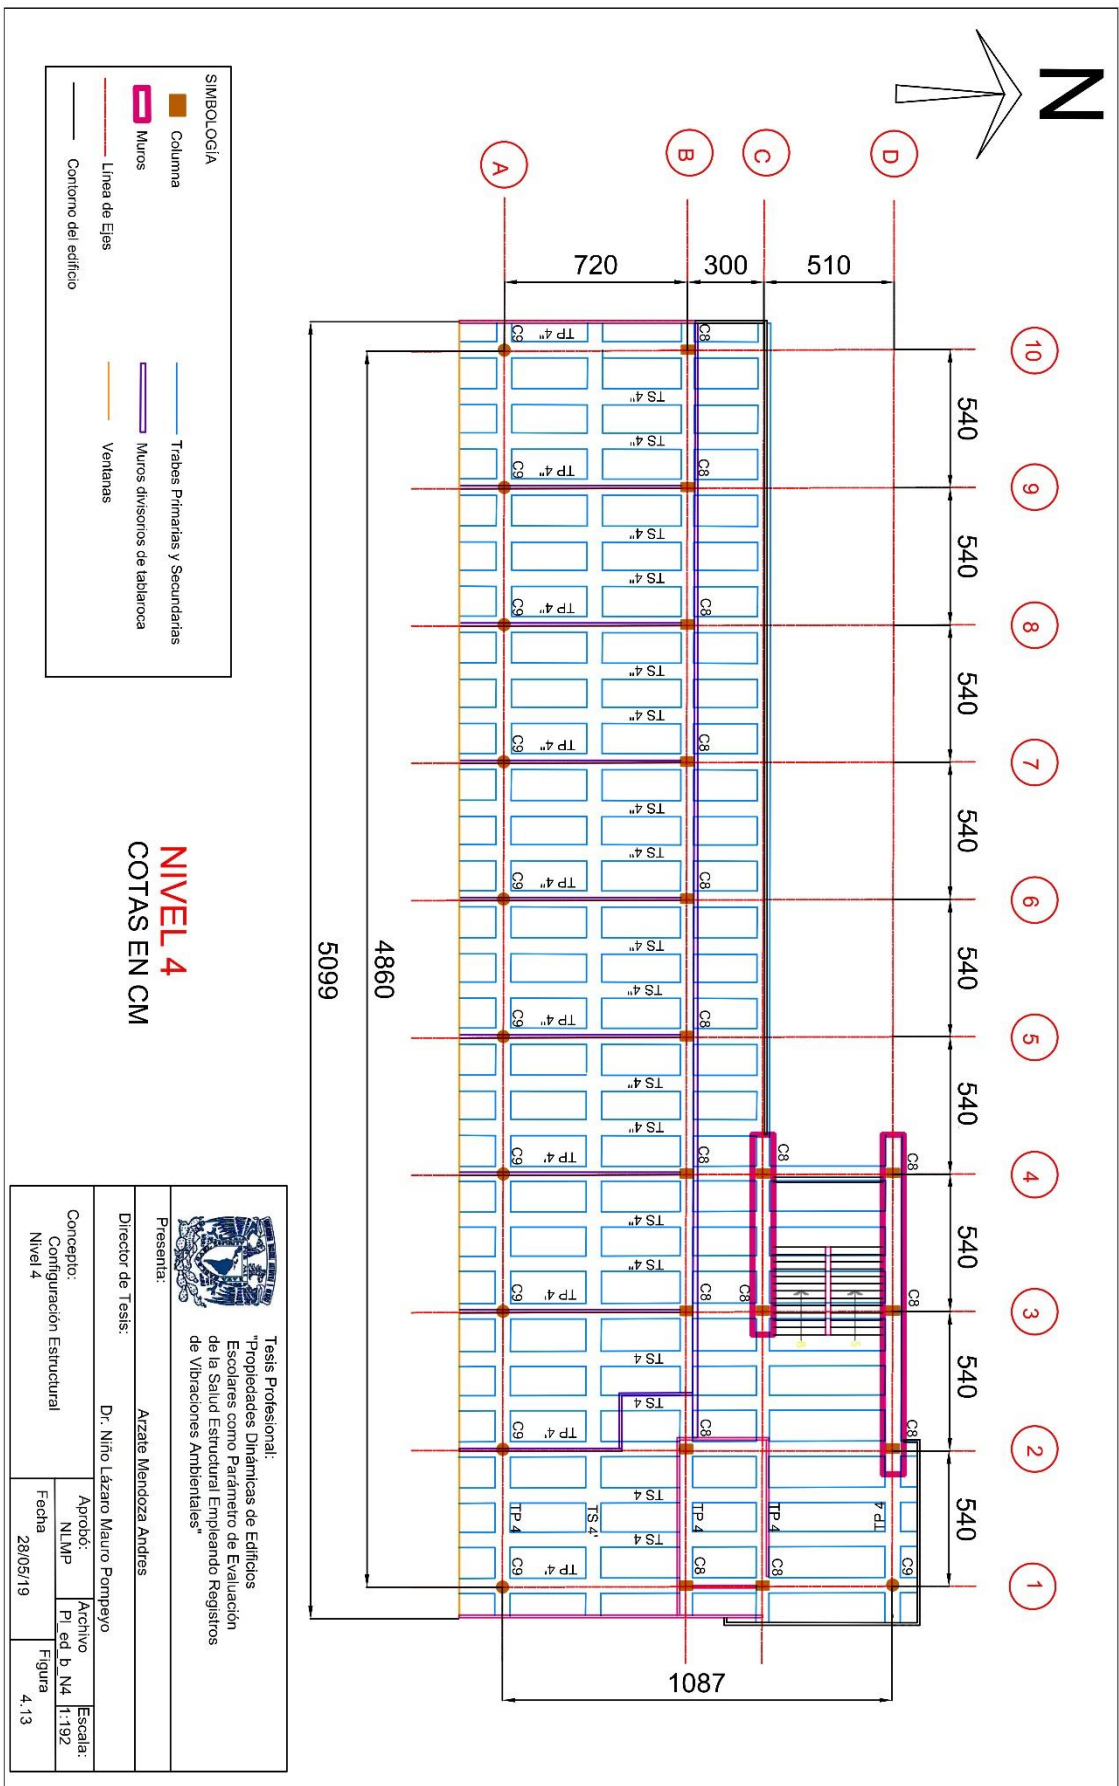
Planta estructural nivel 4 edificio B FI, UNAM
